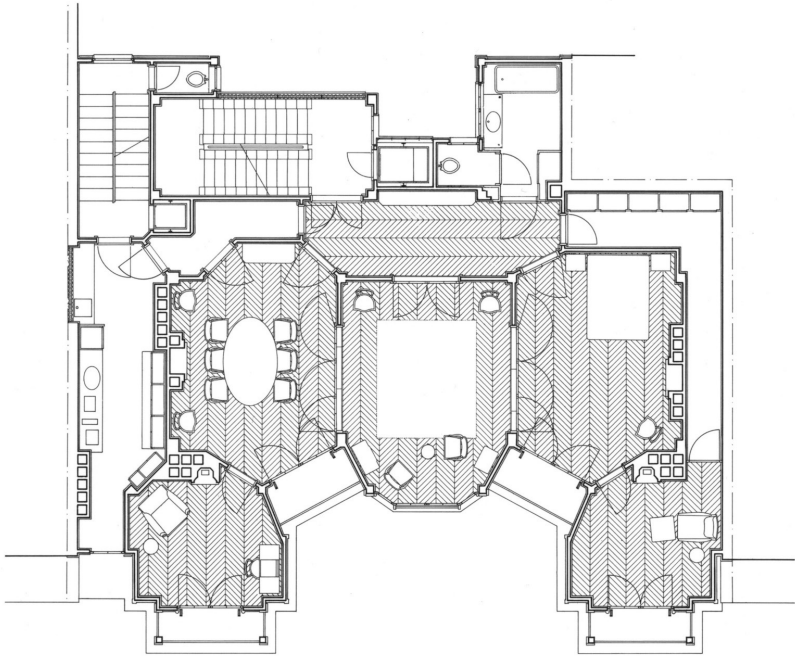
Auguste Perret. Apartmenthaus 25bis, rue Franklin, Paris, 1903/04, Grundriss Wohnung
